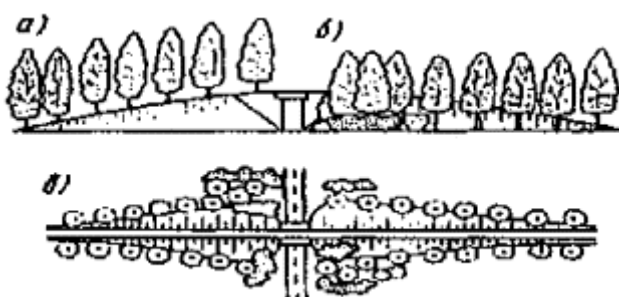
Декоративные посадки у насыпи на подходах к путепроводу:
